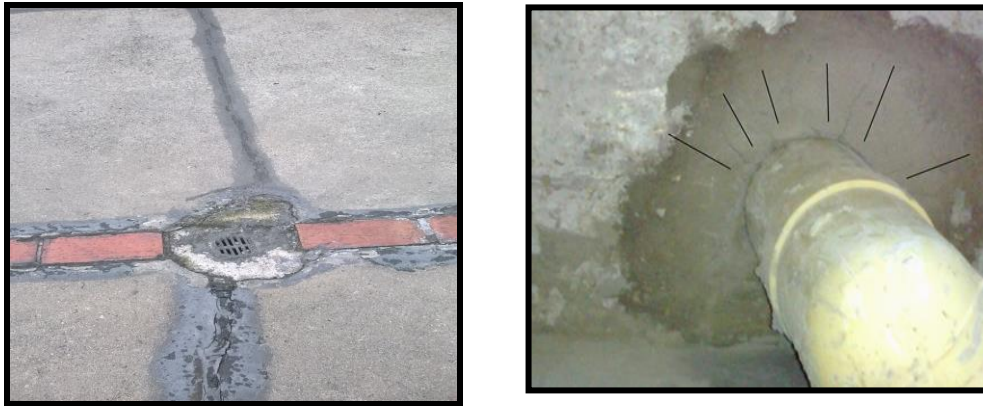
Material de relleno alrededor de los sifones. Fuente: construcción autores
